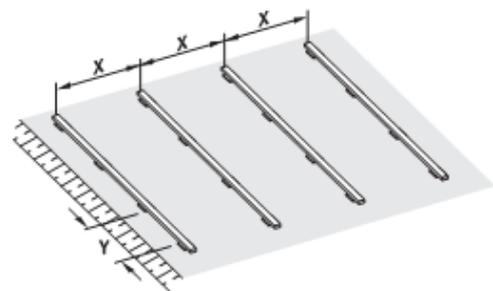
Укладка с резиновыми подушками на бетонный пол
